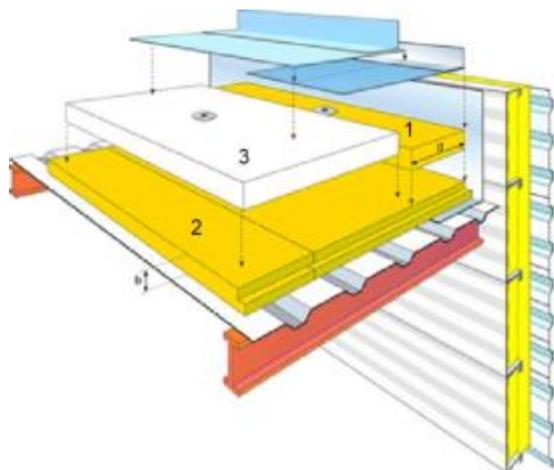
Principe de mise en œuvre du procédé Stisolétanch® Protect sur tôles pleines, avec le jointolement JOINT PROTECT LR (B ou C) en rive posé parallèlement à l'élément porteur
